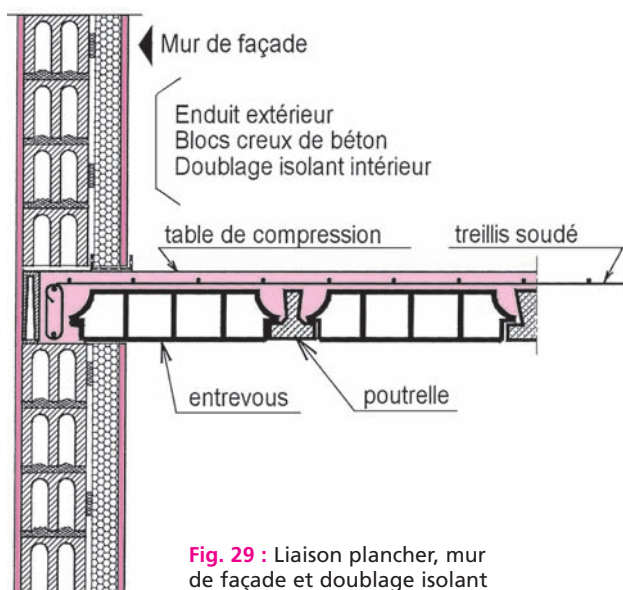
Liaison plancher, mur de façade et doublage isolant
